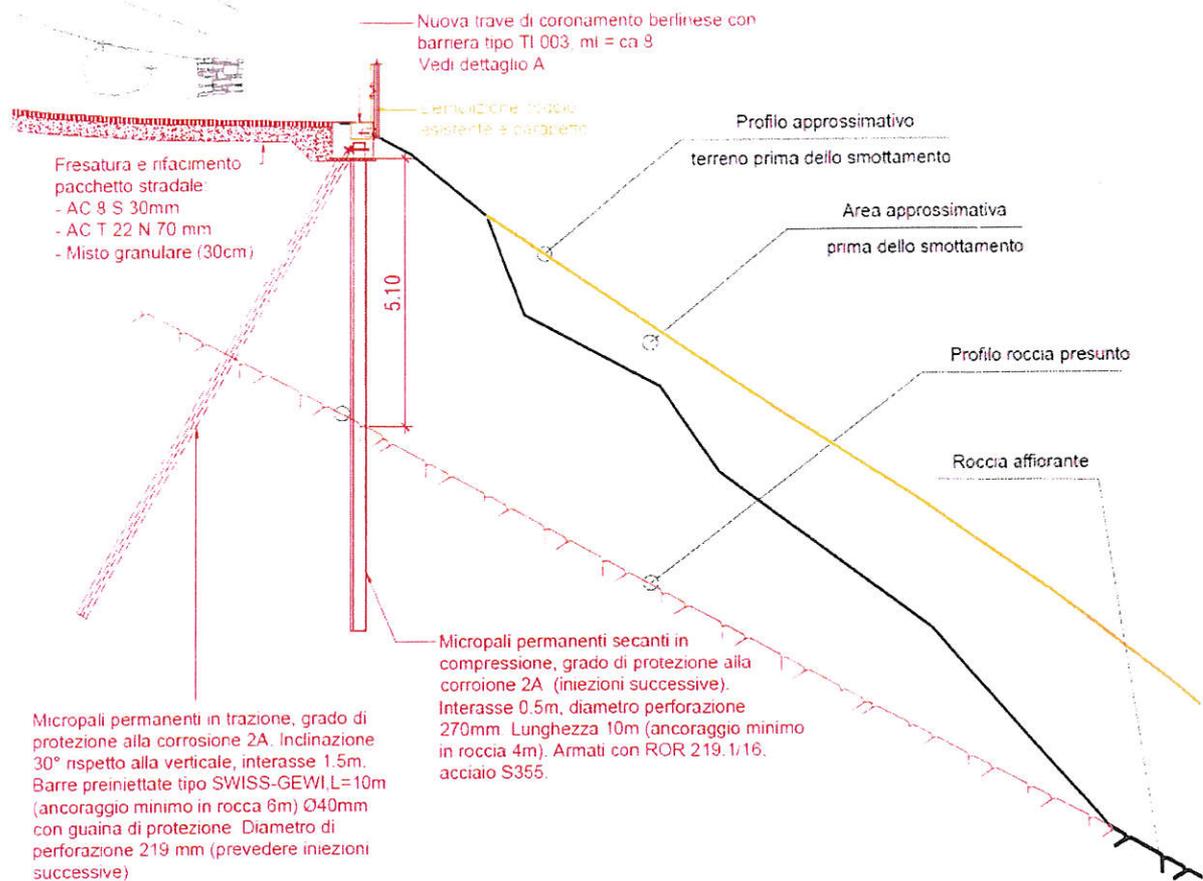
estratto piano P03 sezione tipo intervento messa in sicurezza tornante
